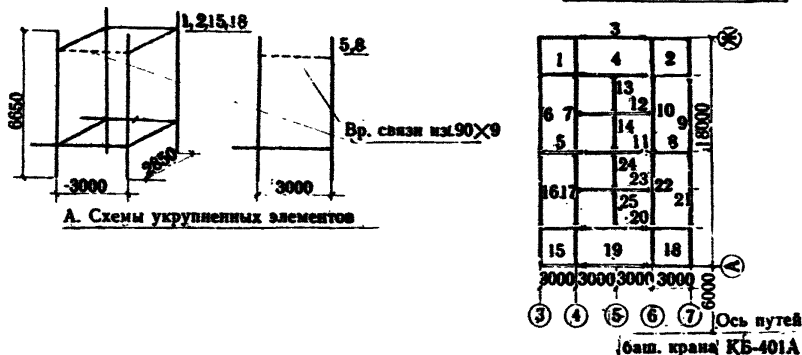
Технологическая схема монтажа II яруса металлических конструкций надстройки рабочего здания РС 4x175 одним башенным краном
